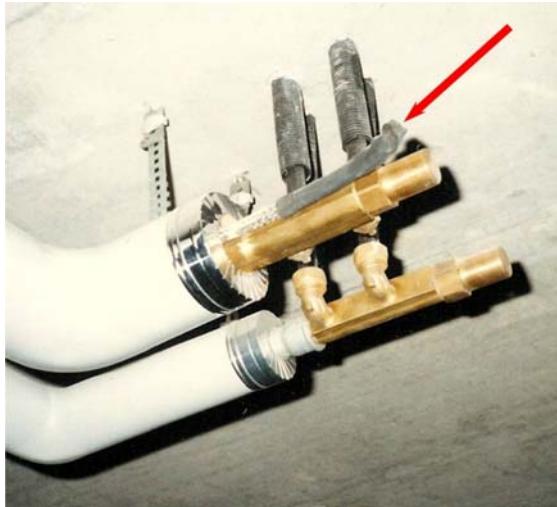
Heizband-Ausführungsdetails Abschluss, Wasserzähler
